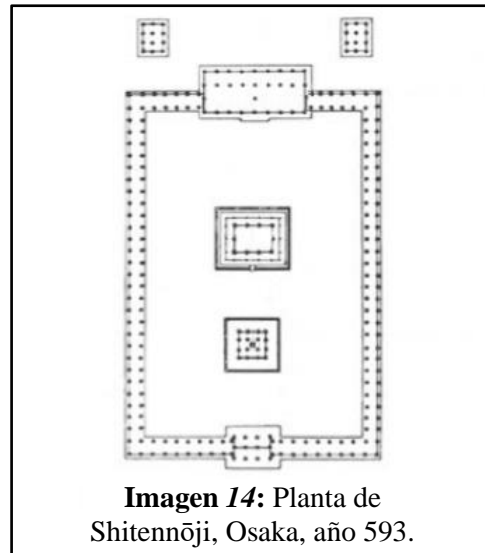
Planta de Shitennōji, Osaka, año 593.
